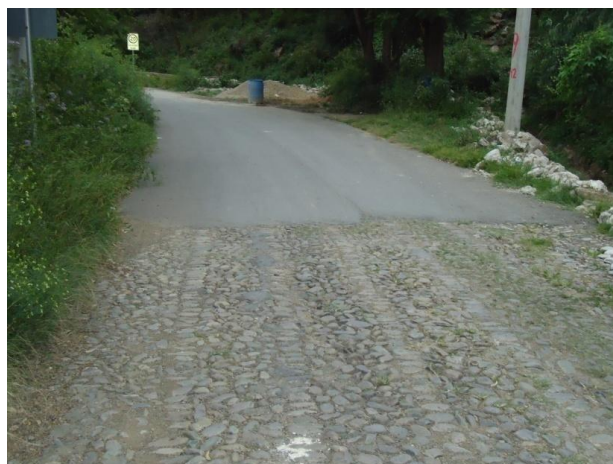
Imprimación Bituminosa y Colocado de la Carpeta Asfáltica sobre Empedrado Fuente: G.M. Tarija
